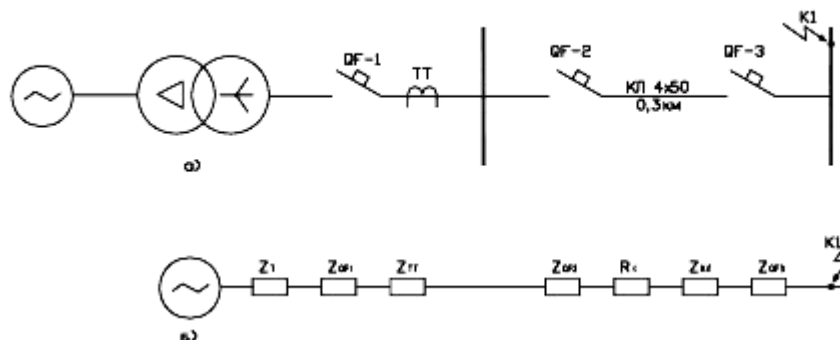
Расчетная схема (а) и схема замещения(б) жилого дома
